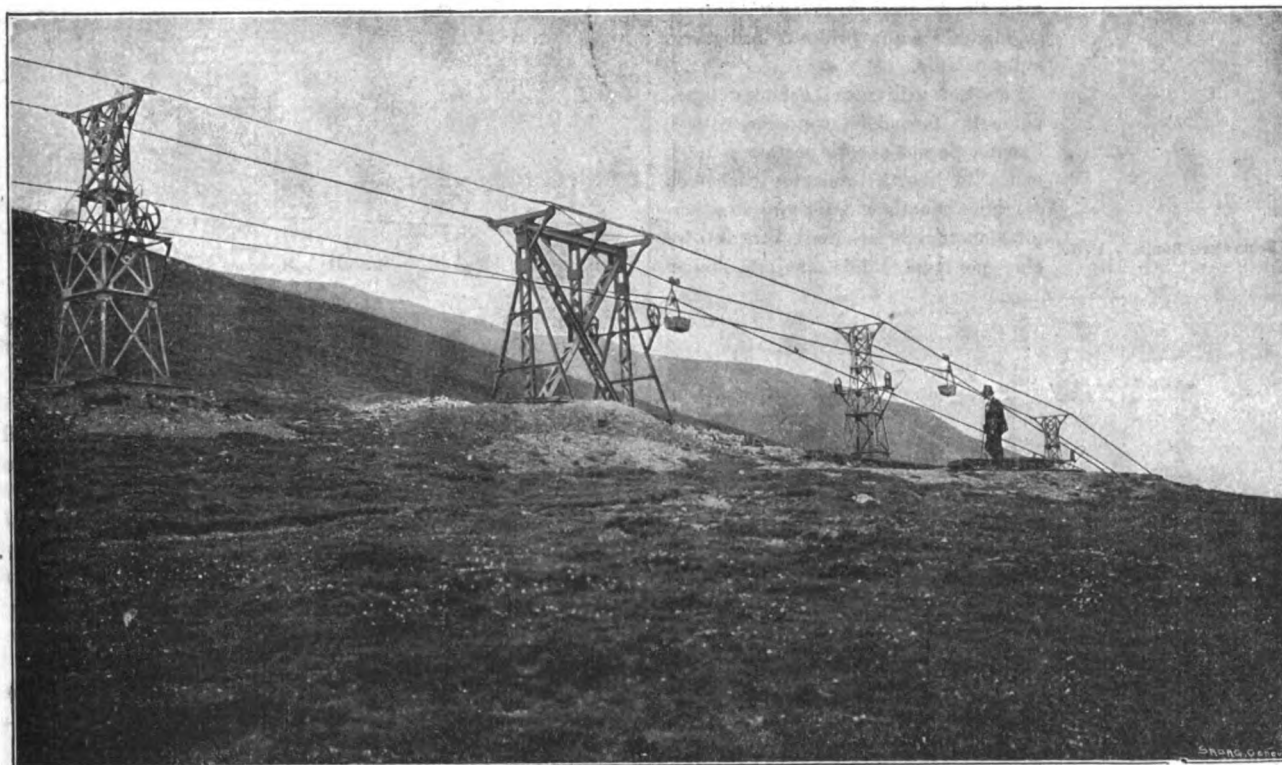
Culmine della ferrovia aerea di Pierrefitte. - Vista.
